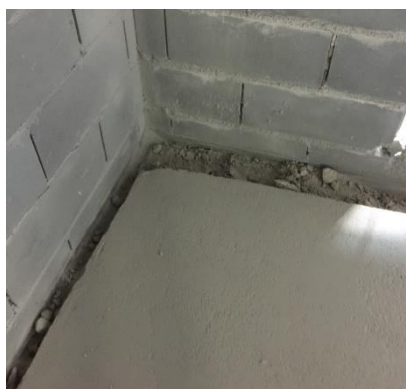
Picagem do pavimento [Data: 16.05.2017]
